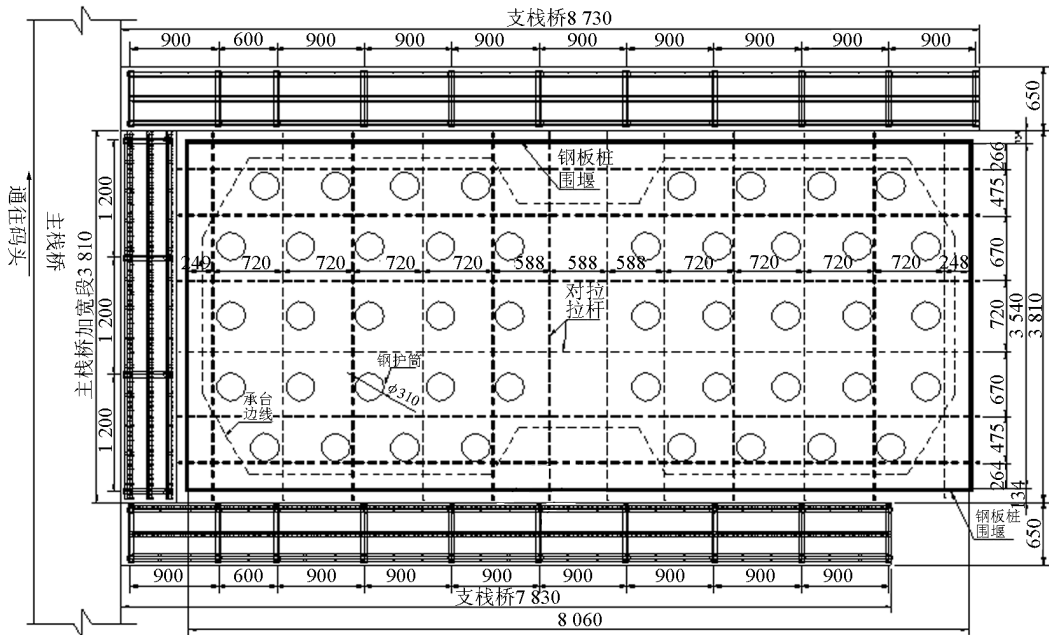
钢板桩围堰钻孔平台及支栈桥平面布置图(单位:cm)
